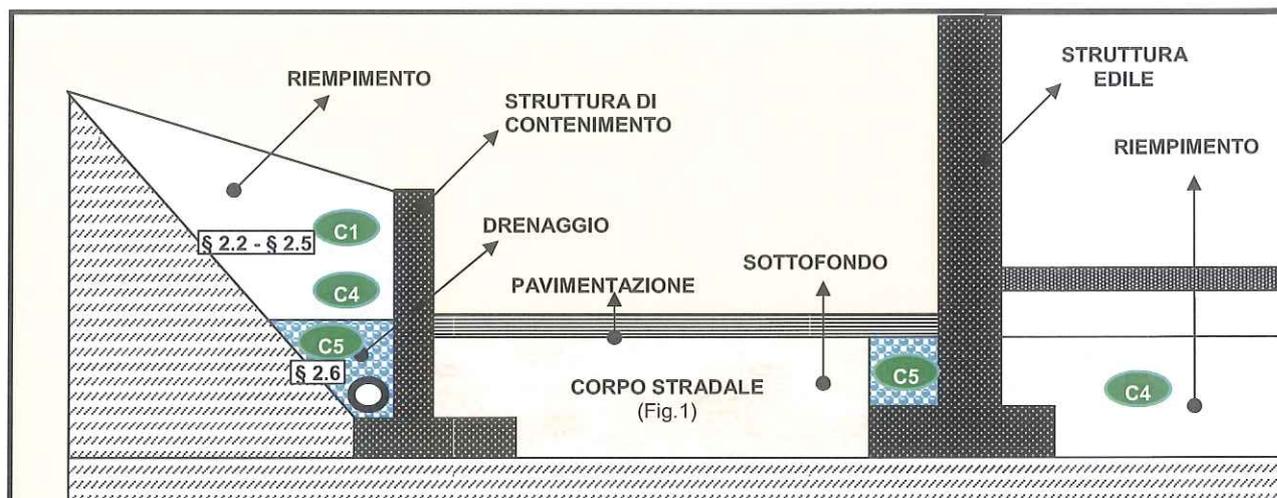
Riempimenti e drenaggi (costruzione stradale e costruzione edile)
